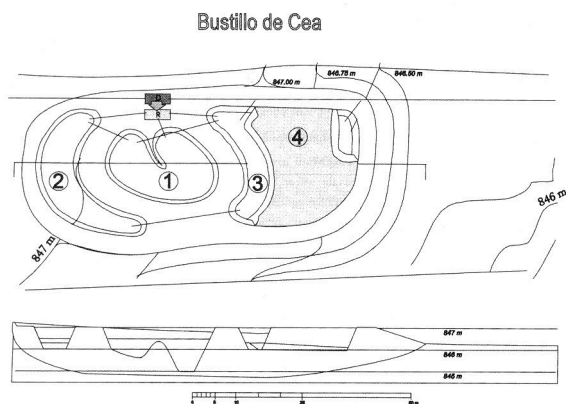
Esquema del sistema en planta. ● Puntos de muestreo.
